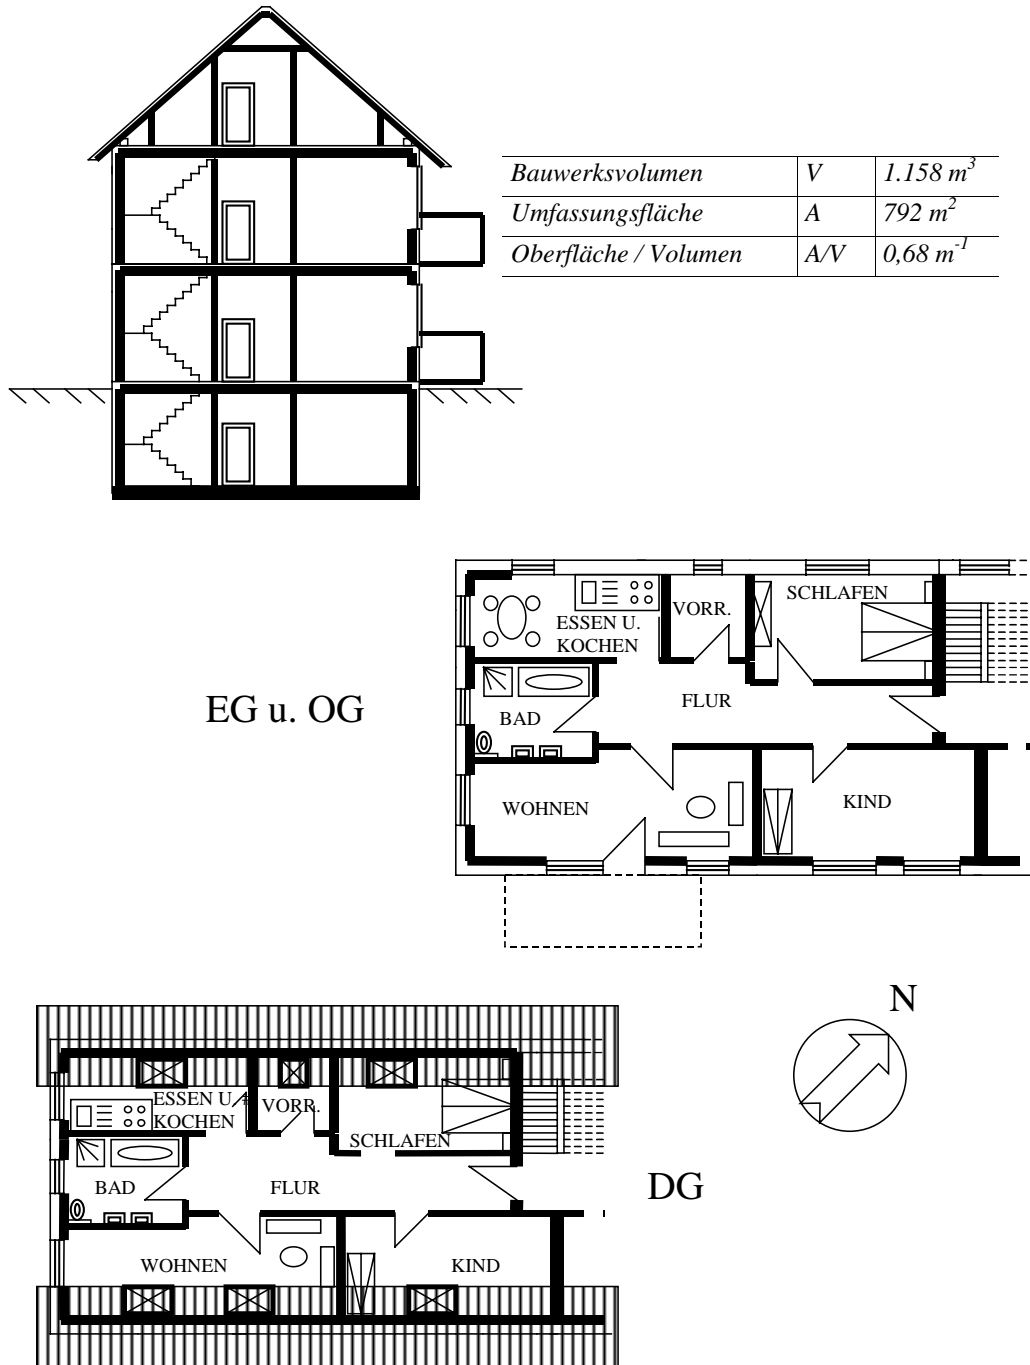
Seitenansicht und Grundriss des Gebäudes EFH 80
